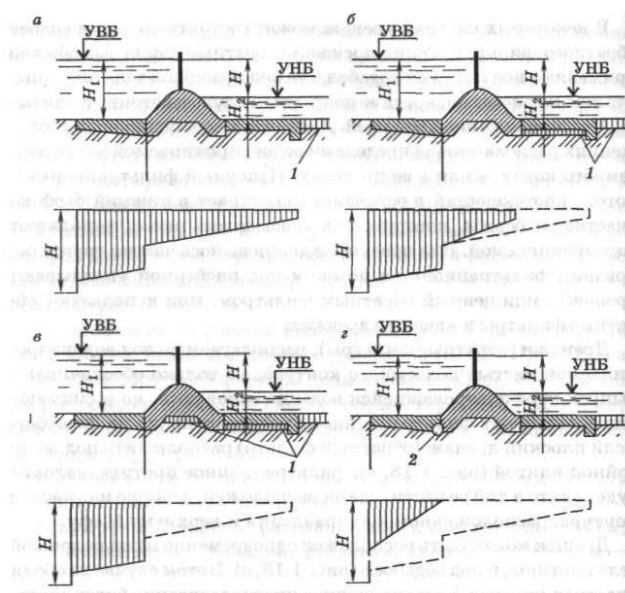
Размещение дренажей по подземному контуру: а – за водобоем, под рисбермой; б – под водобоем; в – под телом плотины; г – в конце понура; 1 – дренаж; 2 – плоский дренаж; 3 – дренажная галерея.
